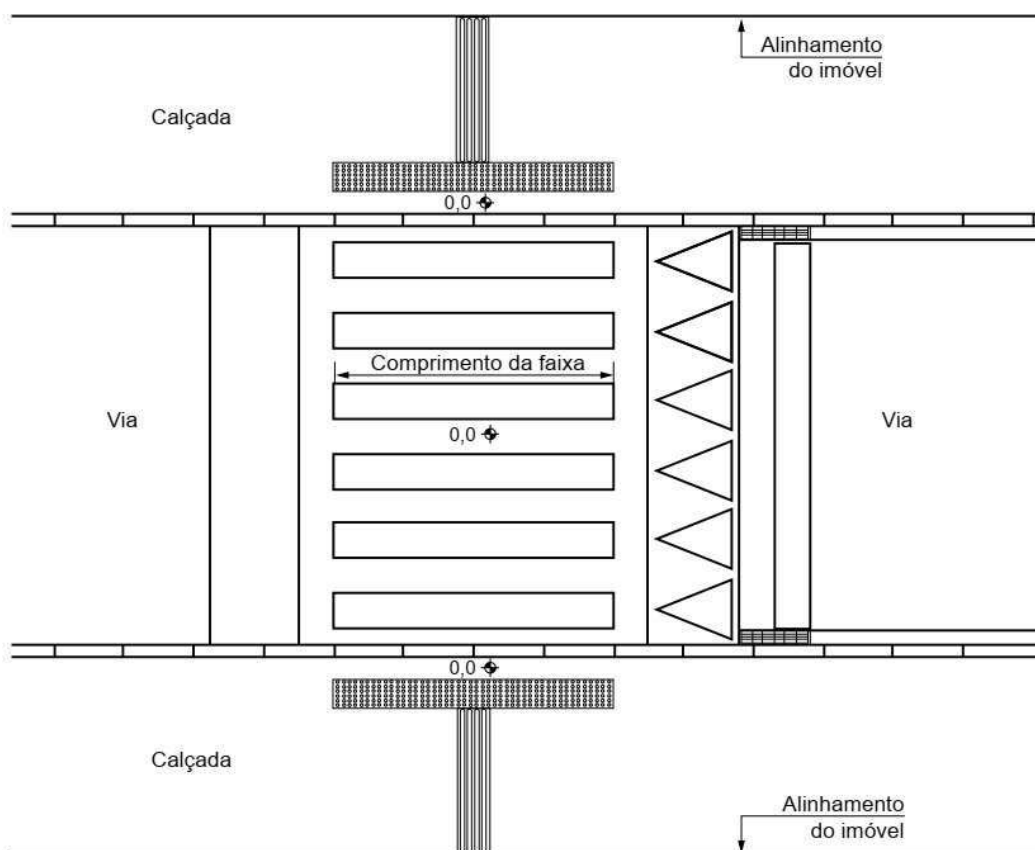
Faixa elevada para travessia – Exemplo – Vista superior
